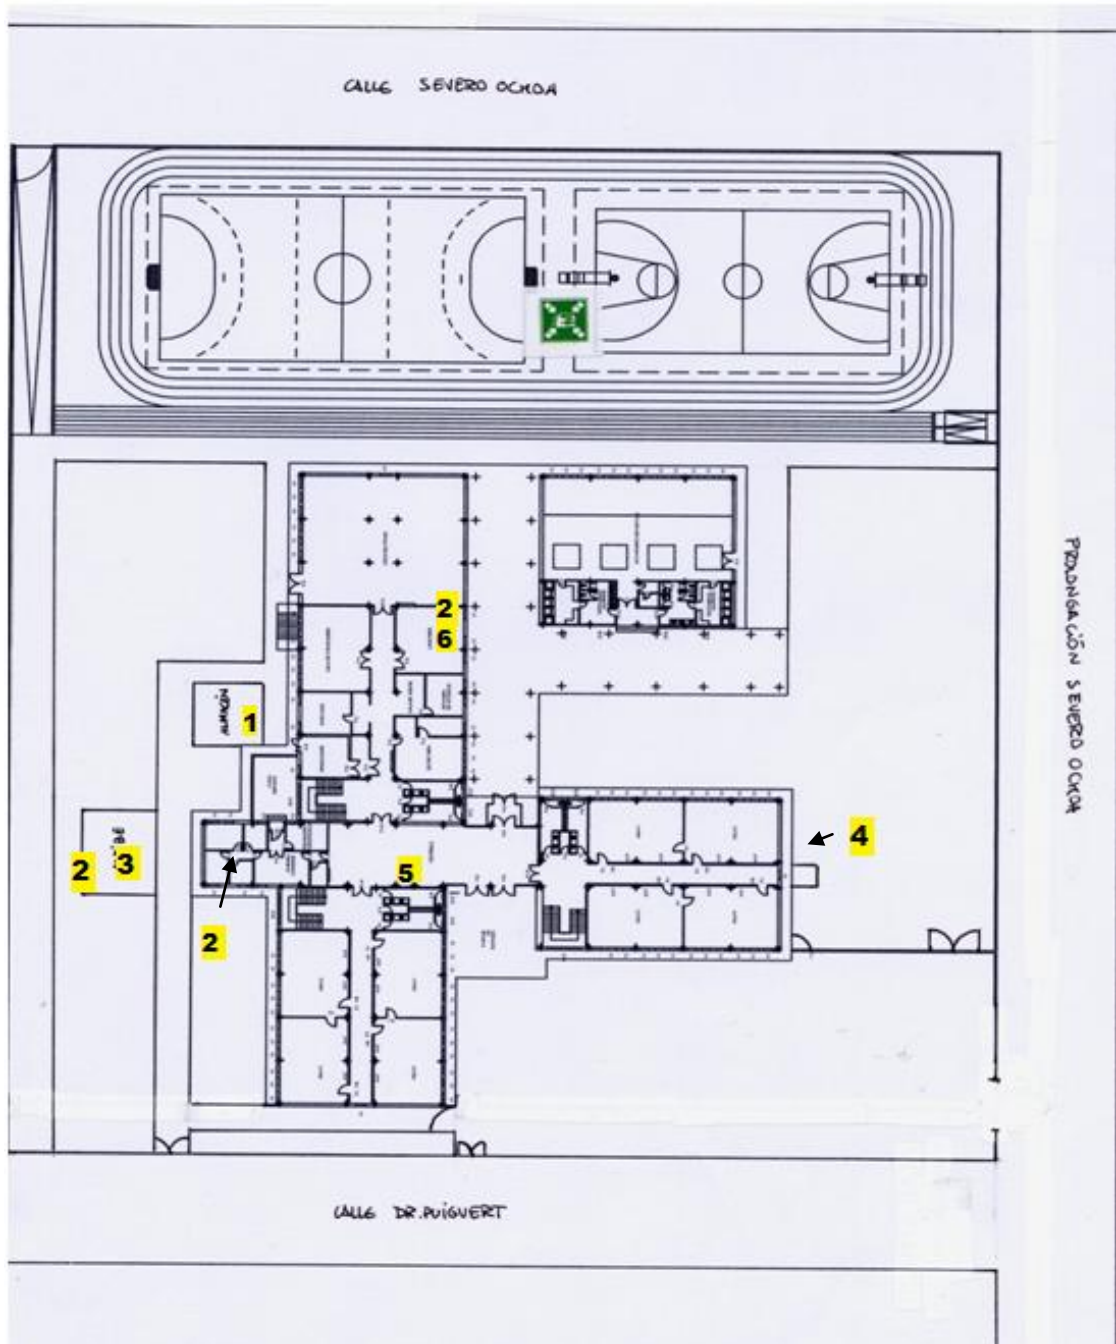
Ubicación elementos e instalaciones de riesgo – Plano planta general.
